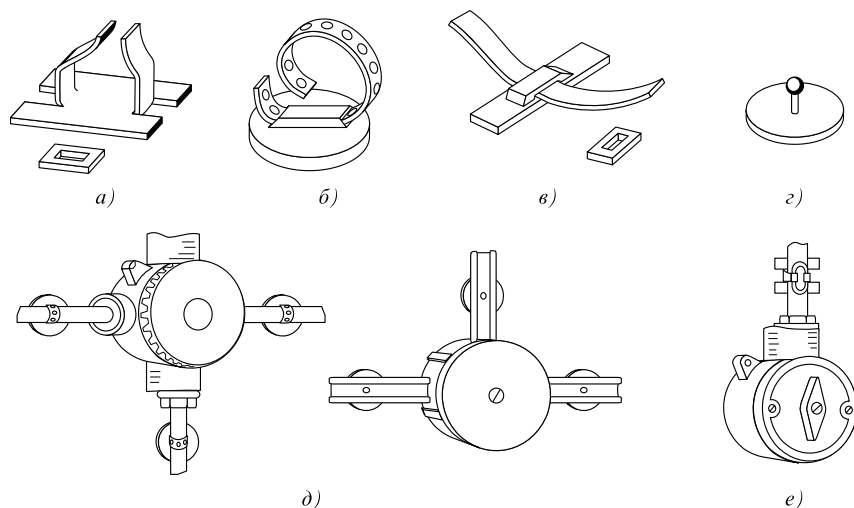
Крепежные детали и установочные изделия для приклеивания: *a* – деталь из жести с пряжкой; *б* – деталь из пластмассы или металла в комплекте с поливинилхлоридной лентой и кнопками из полистирола; *в* – деталь из пластмассы или металла в комплекте с плоской полосой и пряжкой; *г* – пластмассовая деталь для крепления проводов; *д* – соединительные коробки; *е* – полугерметический выключатель
